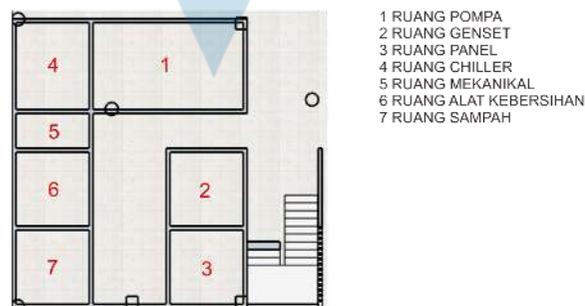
Zonasi Ruang Pengelola Lantai 1
